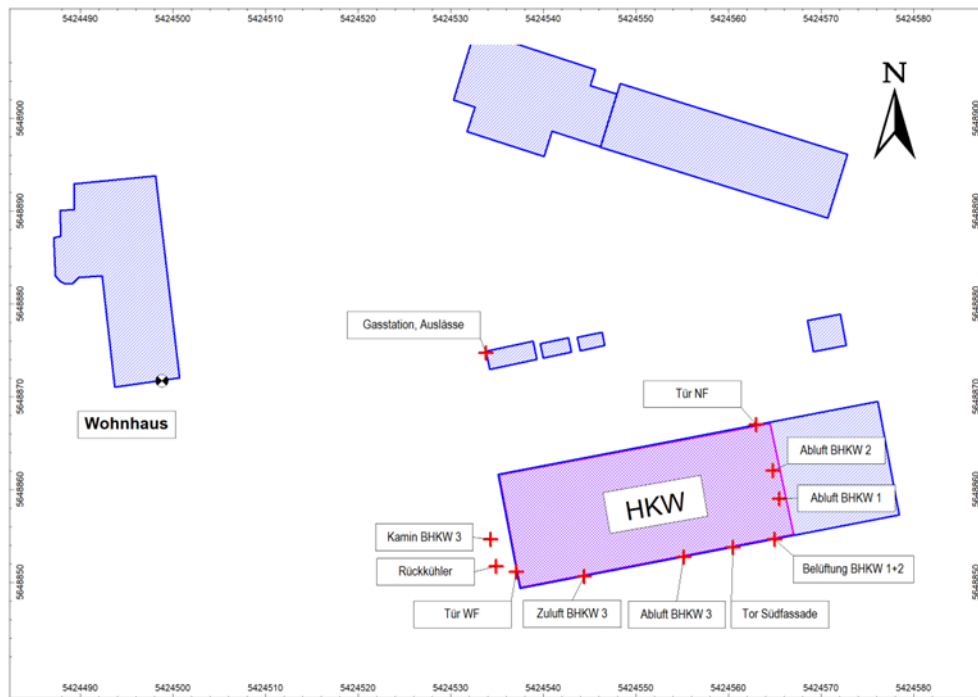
Lageplan mit Anlage 3 und Immissionsort.
